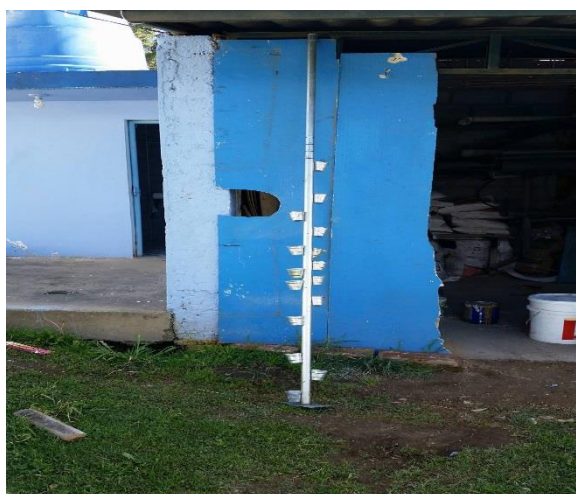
Varilla soldada con placas metálicas para la determinación de la expansión.
